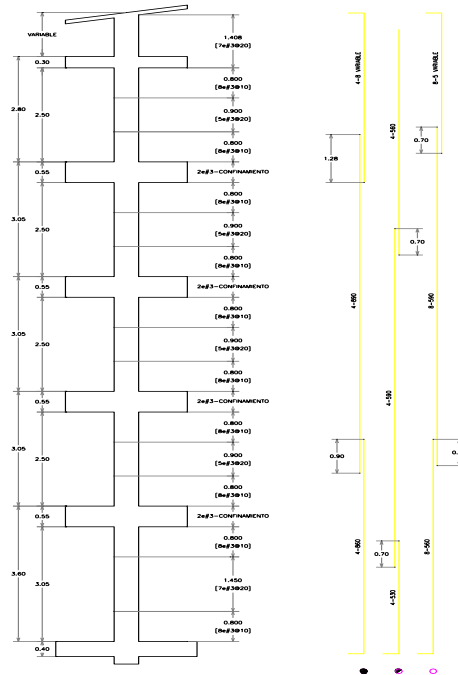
Colocación del acero de refuerzo a lo largo del edificio
